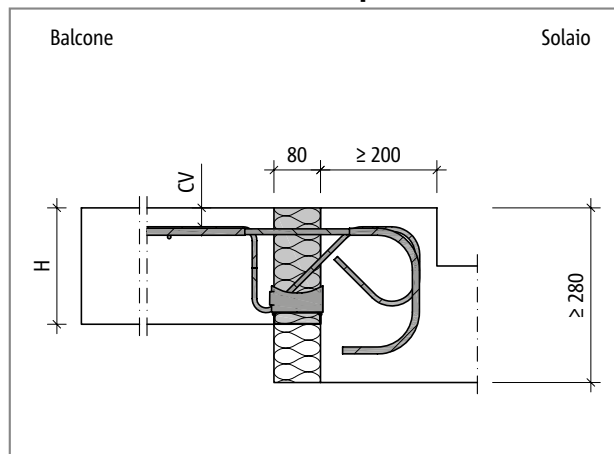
Schöck Isokorb® tipo K70M-UZ – K110M-UZ: balcone con innalzamento di quota e isolamento esterno
